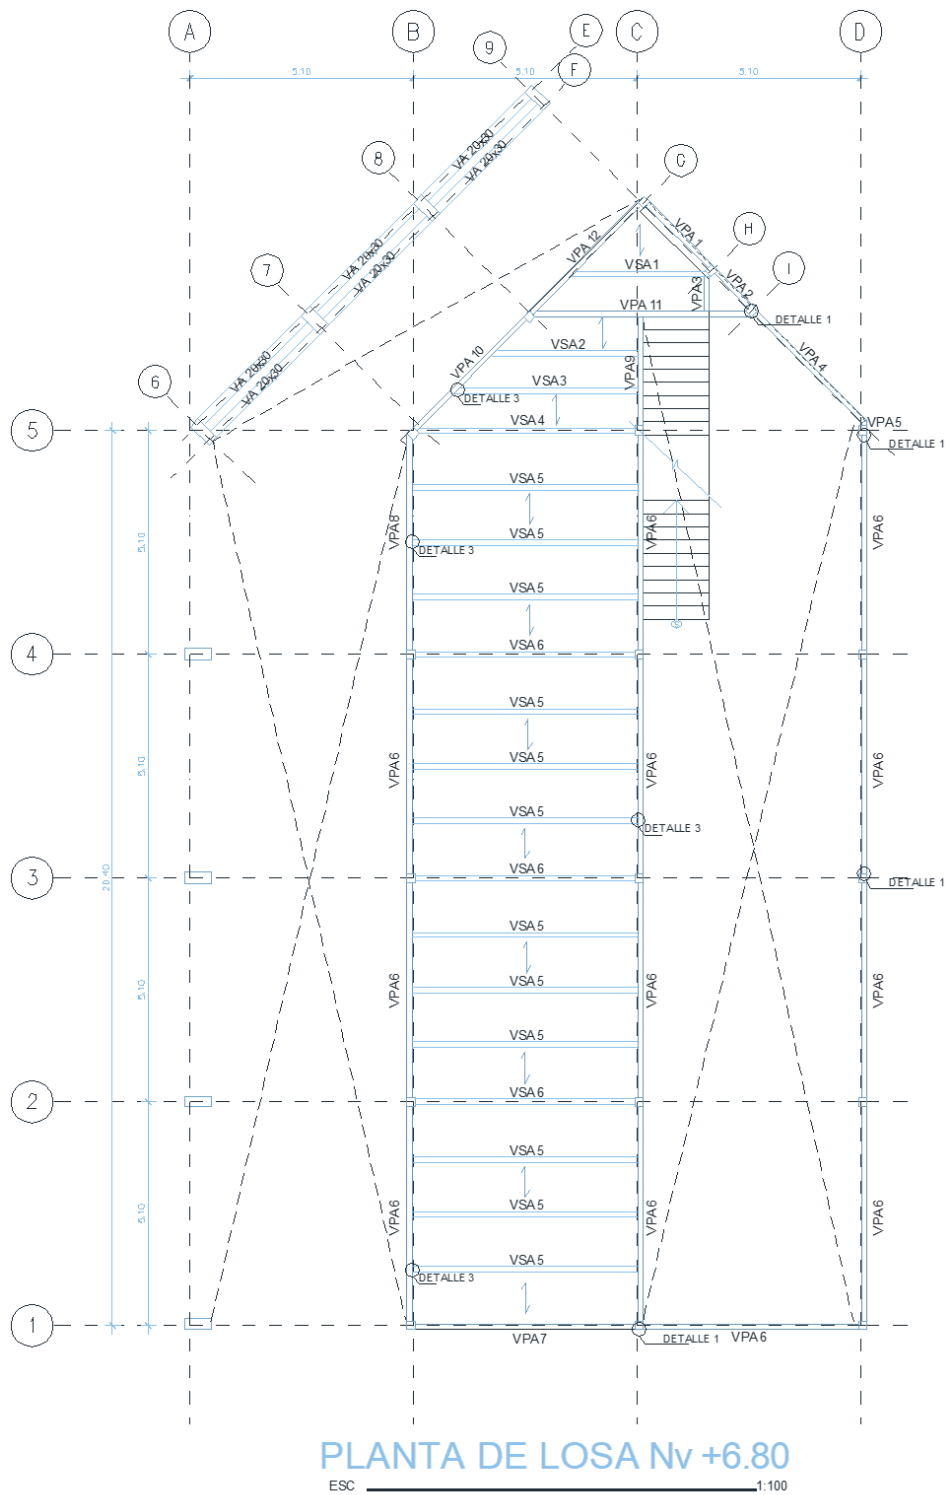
Plano Estructural Planta de Losa Nv +6.80 [25]
